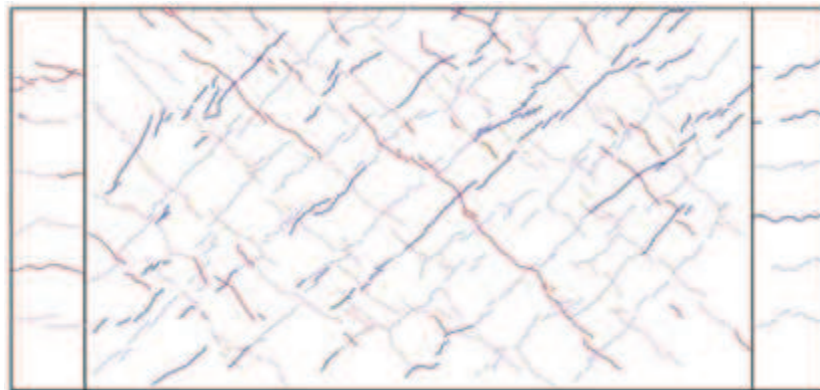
(7) 1/500rad. におけるひび割れ図
